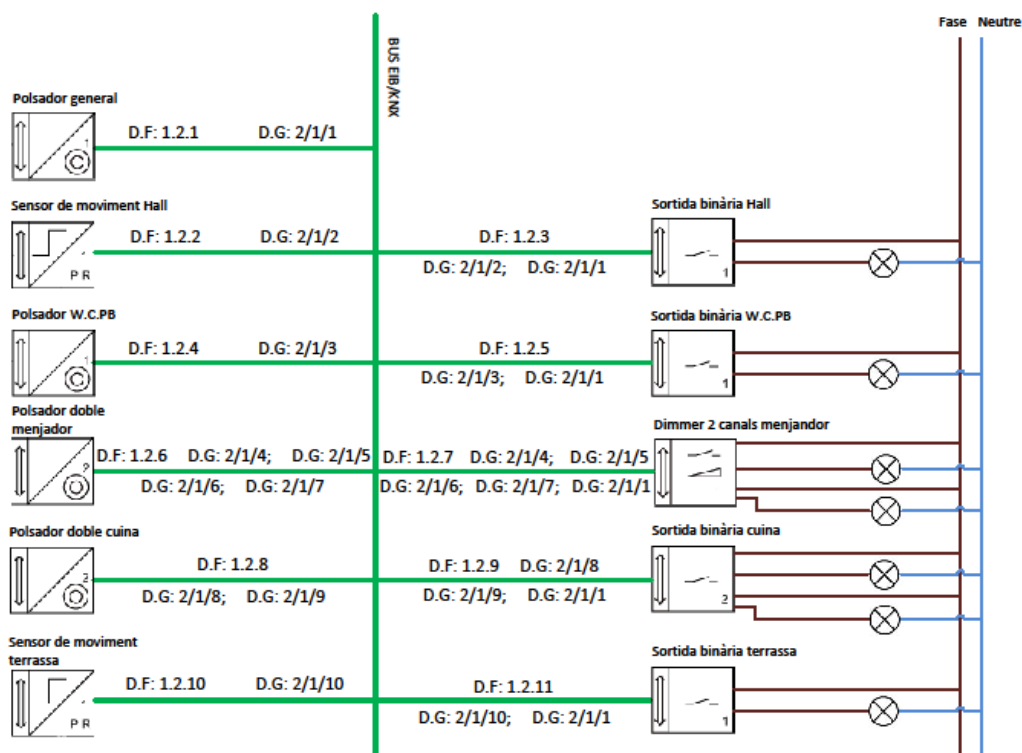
Esquema domòtic d' il·luminació planta baixa
